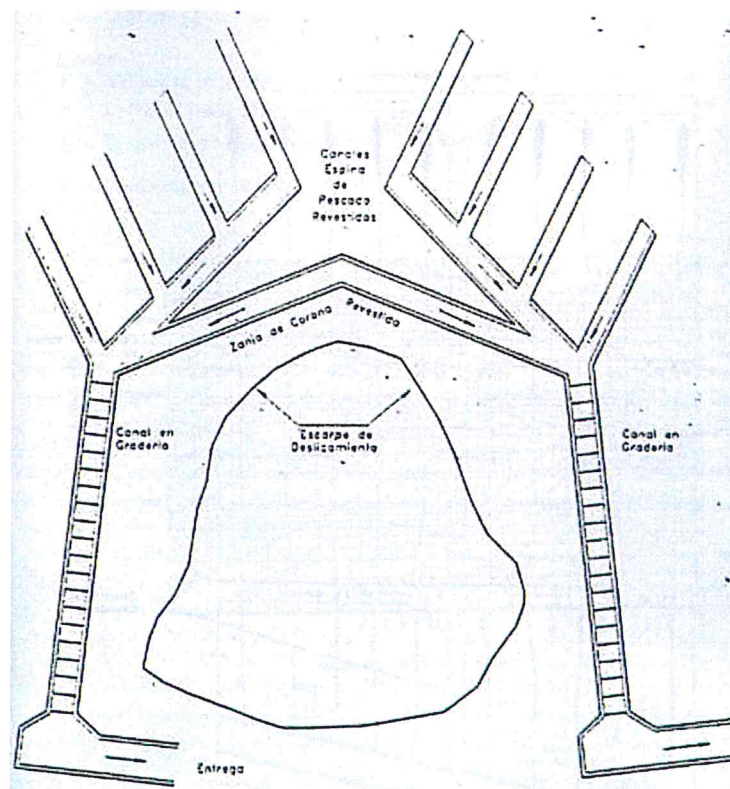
Esquema de planta de canales colectores espina de pescado con canales en gradería
